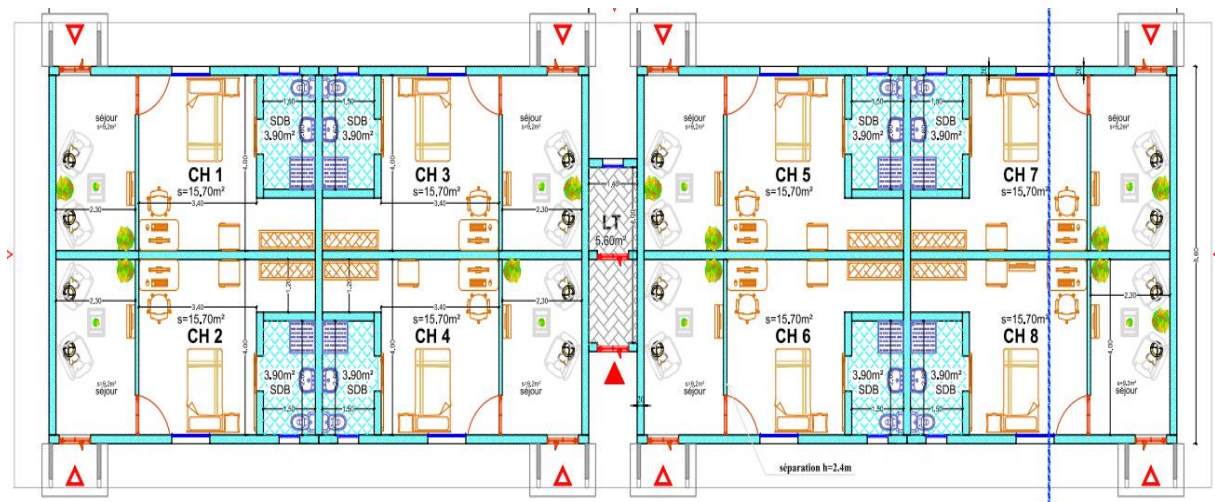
Plan du BLOC B Situé à GASSI TOUIL
